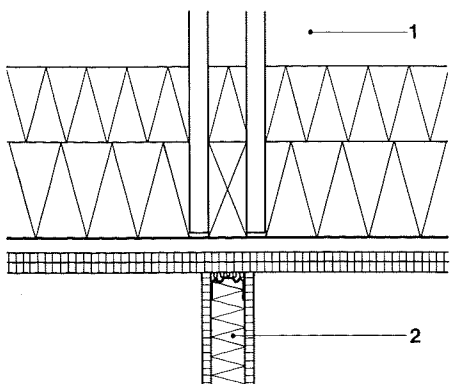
Samling mellem tagkonstruktion af træ og 1-stensvæg ført op over loftsfladen. Lodret snit 1:20.
